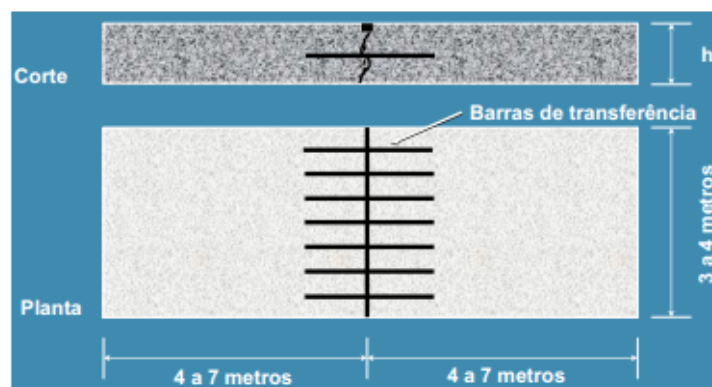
Pavimento de Concreto Simples com Barras de Transferência
